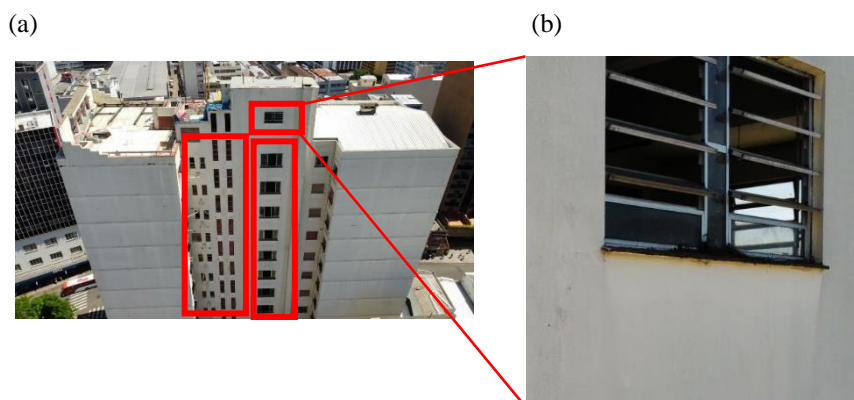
(a) localização e (b) inspeção de trecho ao lado de janela no 12º pavimento.
